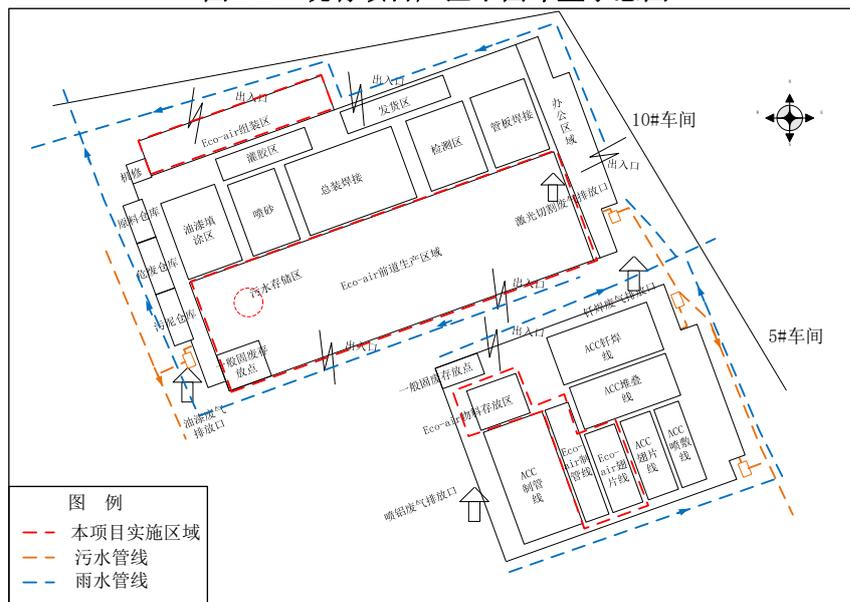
本项目实施后厂区平面布置及雨水管线示意图
